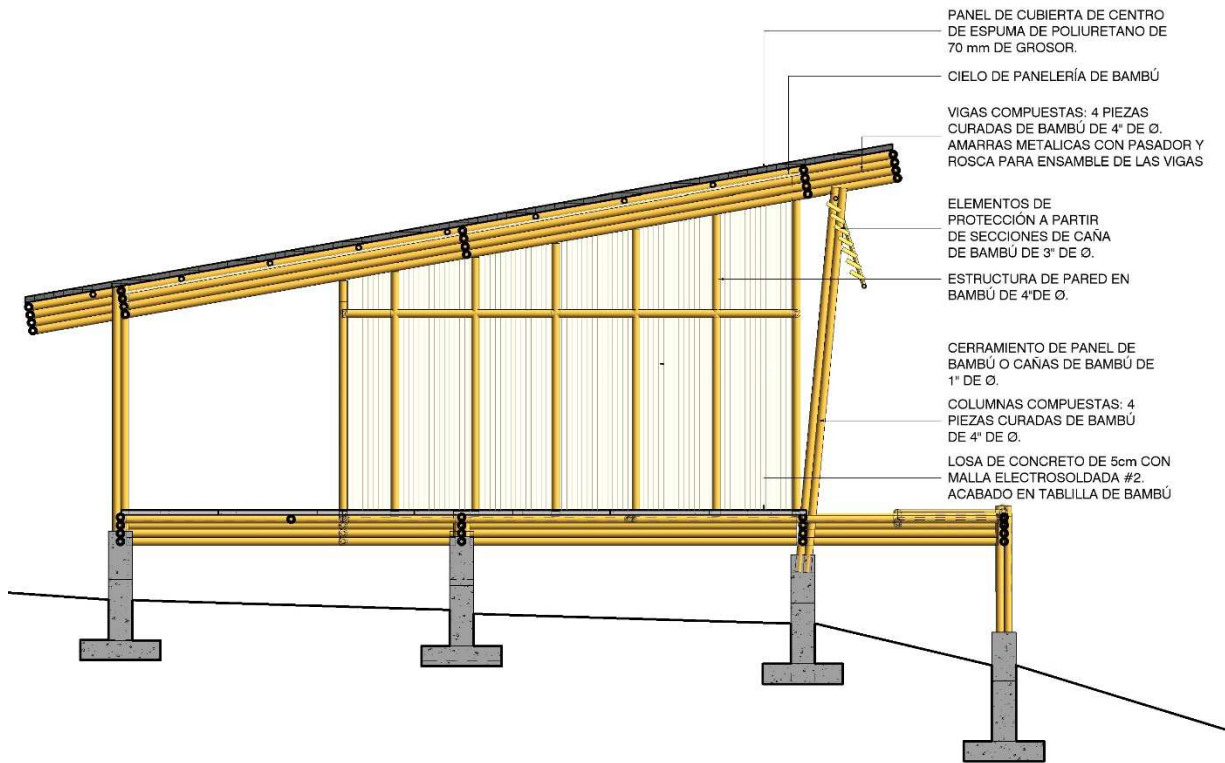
Sección esquemática de la propuesta en bambú. Fuente: Elaborada por el autor.
